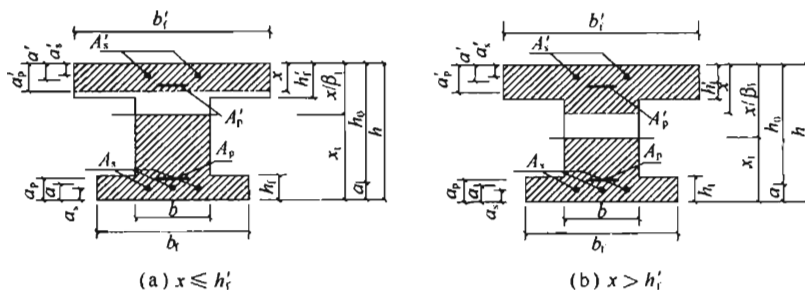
钢筋钢纤维混凝土 I 形截面受弯构件正截面承载力计算
